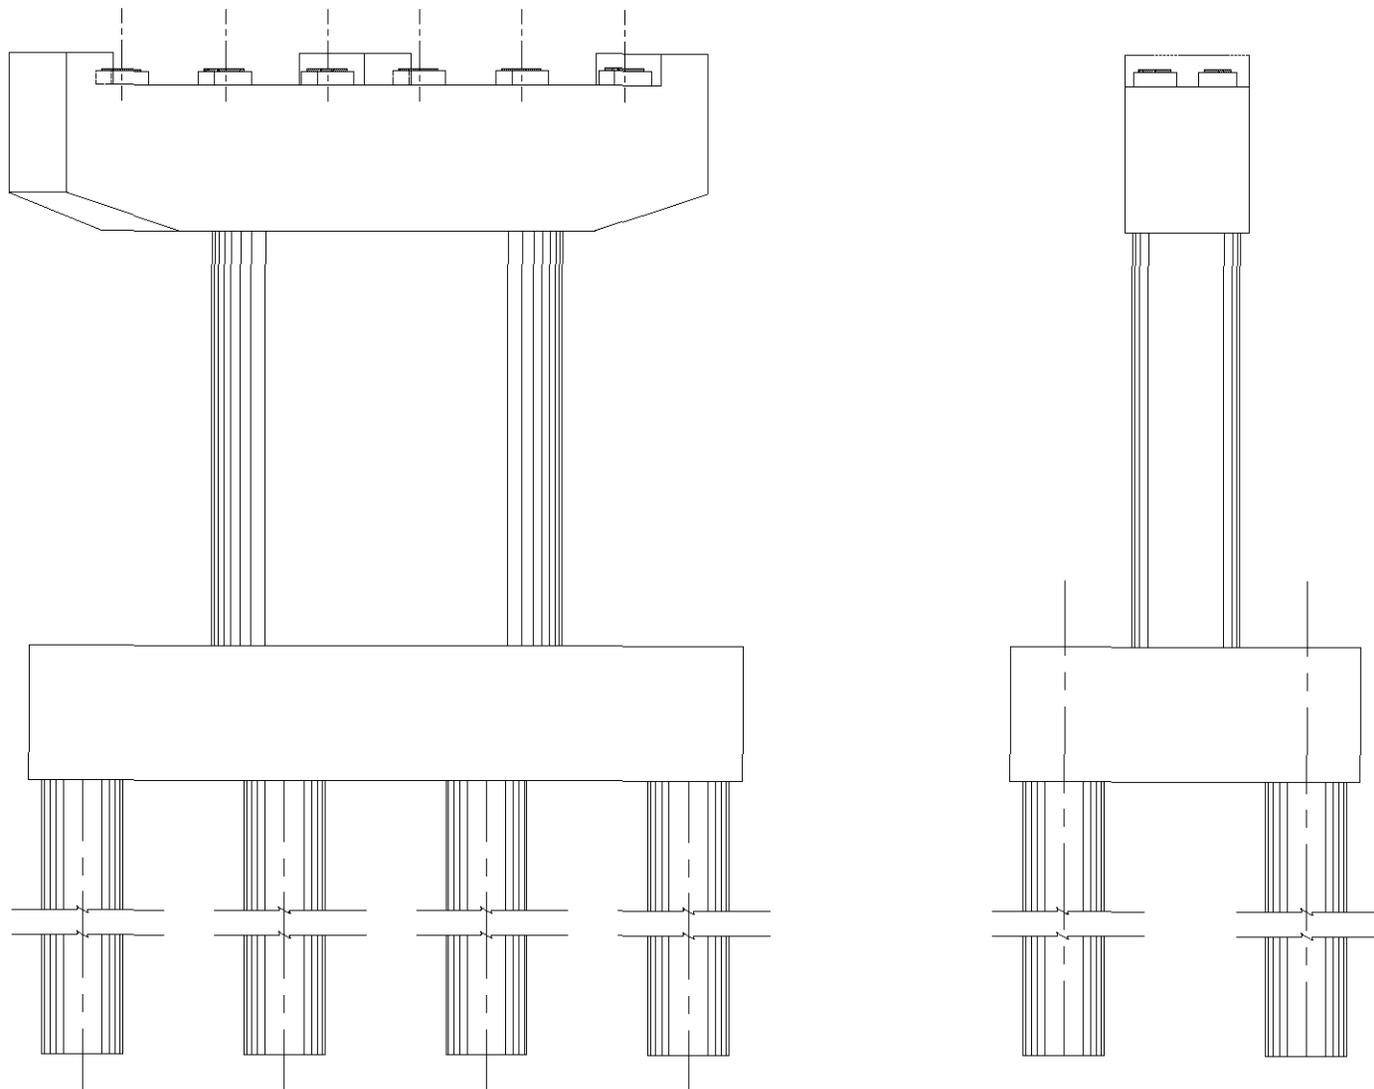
Elemento pila del proyecto "Las Lajas III"
